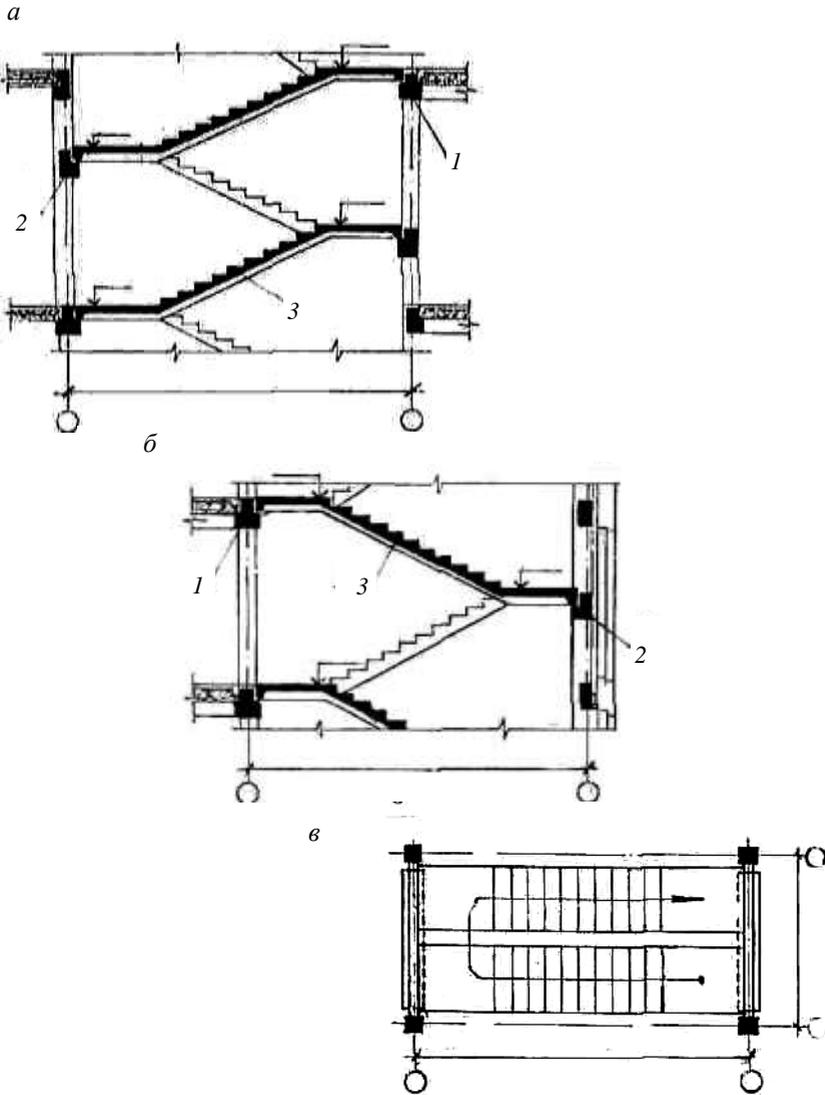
Лестничная клетка каркасного здания: *a* — трехмаршевая лестница; *б* — двухмаршевая лестница; *в* — план лестницы с опиранием на ригели; 1 — ригель каркаса; 2 — ригель лестничного марша; 3 — марш с полуплощадками
